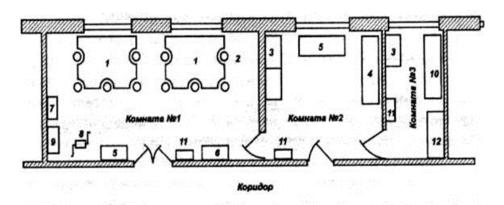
Схема размещения производственных помещений зуботехнической лаборатории: 1-рабочий стол, 2-стул, 3-вытяжной шкаф, 4-гипсовочная, 5-стол для формовки, 6-шкаф, 7-аппараты для протягивания гильз, 8- вальцы, 9-пресс, 10-полировочная установка, 11-раковина, 12-ящик для гипса.
